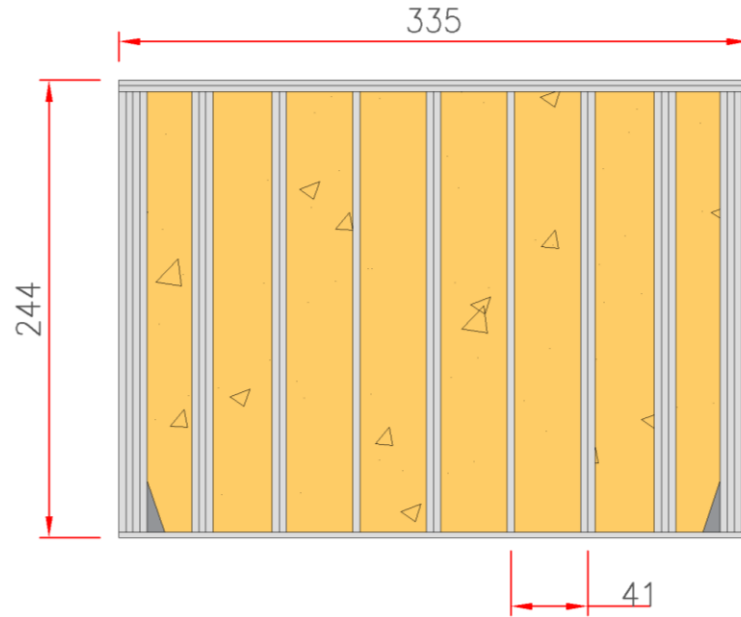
Muro M1, primer piso (medidas en centímetros).
